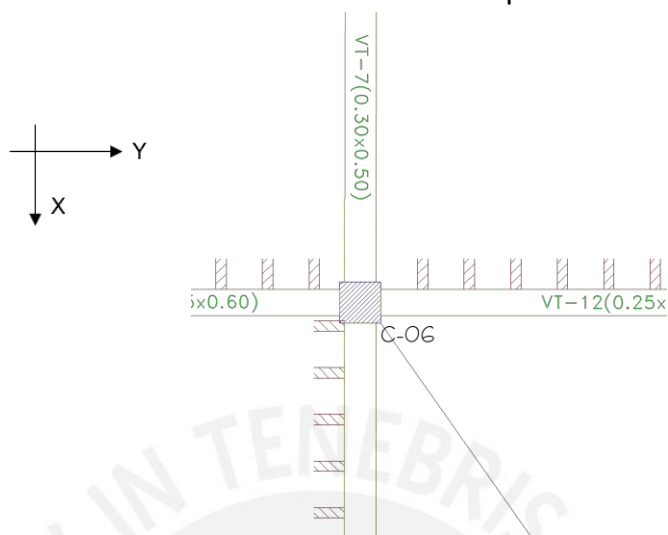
UBICACIÓN EN PLANTA DE LA COLUMNA A DISEÑAR.
